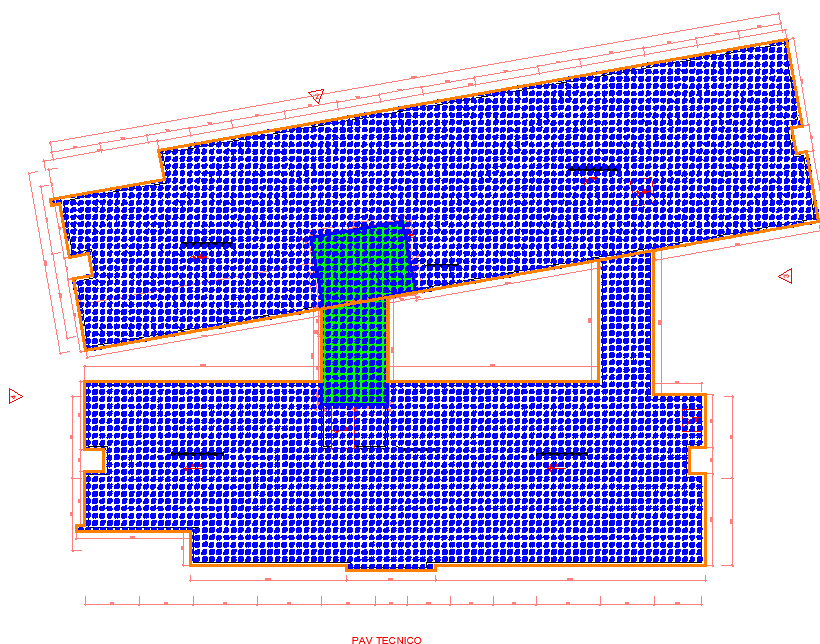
Área considerada para pavimento tipo (Pavimento Técnico)
